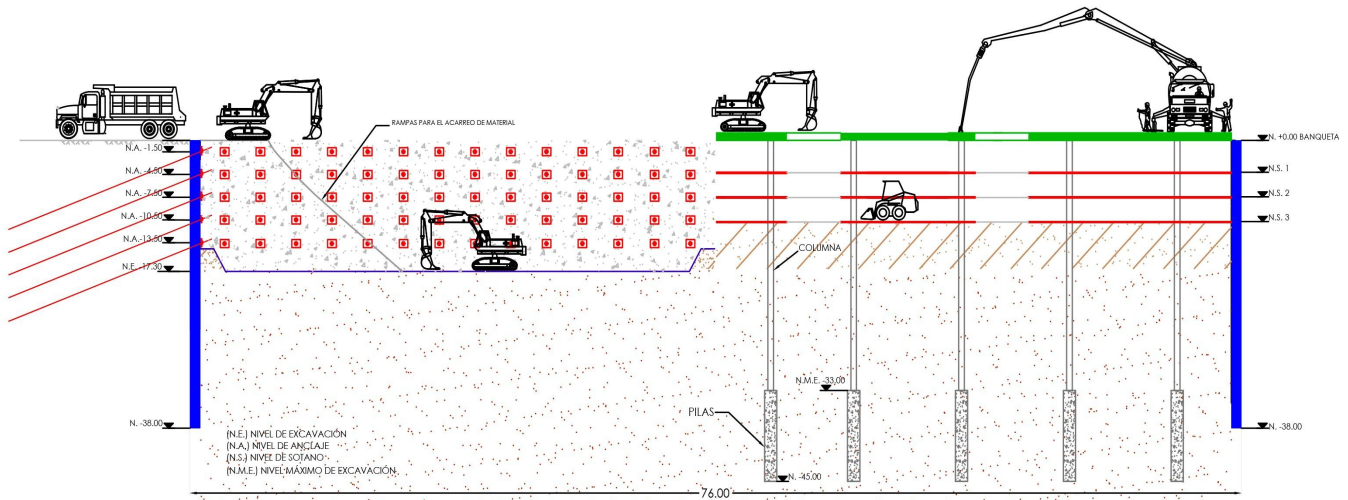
Excavación para ejecución del 5to nivel de anclaje y 3er sótano.
